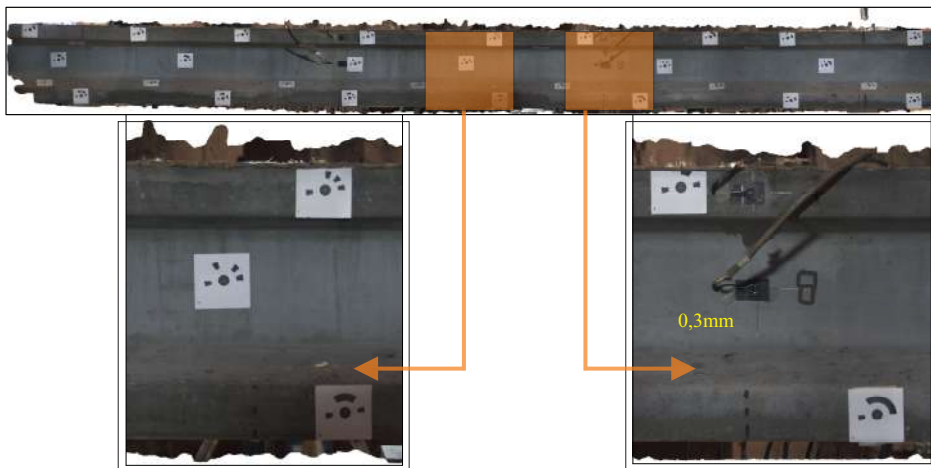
Fissuração máxima no 2º Ciclo - Viga UHPFRC (V03)
